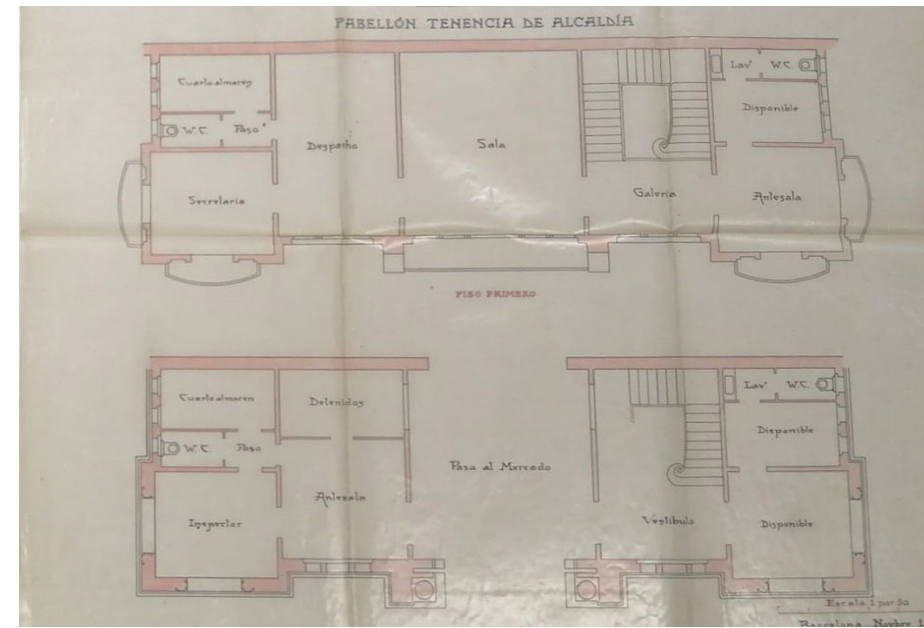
Plano de la fachada de la tenencia de Alcaldía
